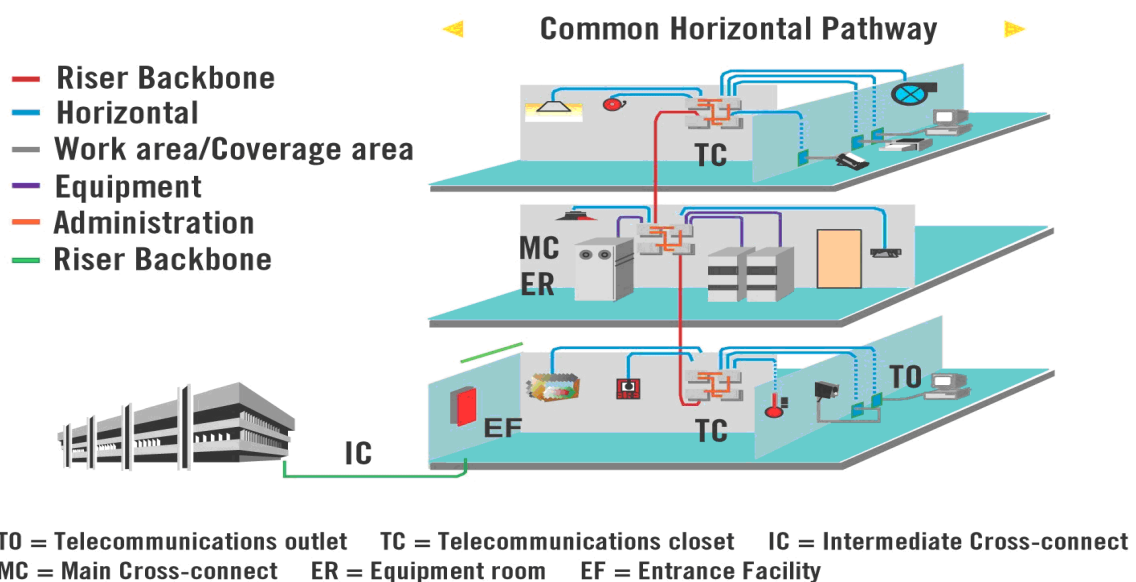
Schema generale di un Cablaggio Strutturato (Fonte Systemax)
